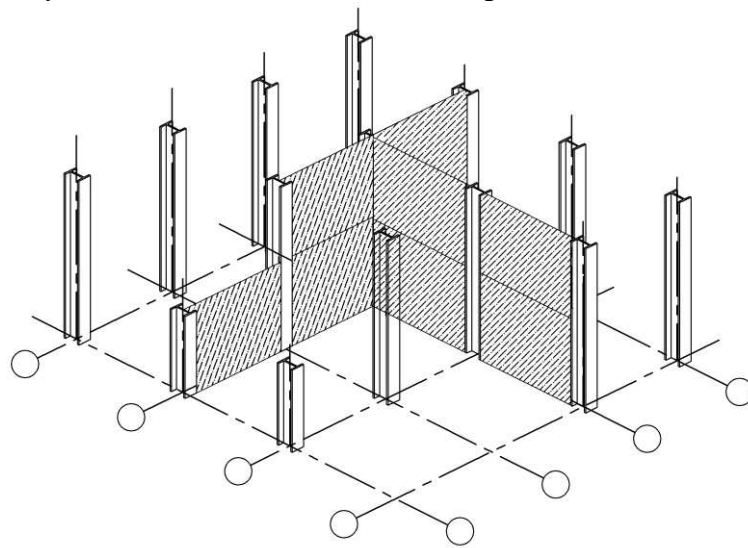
Вертикальные связи в виде сплошных стен (перекрытия условно не показаны)
